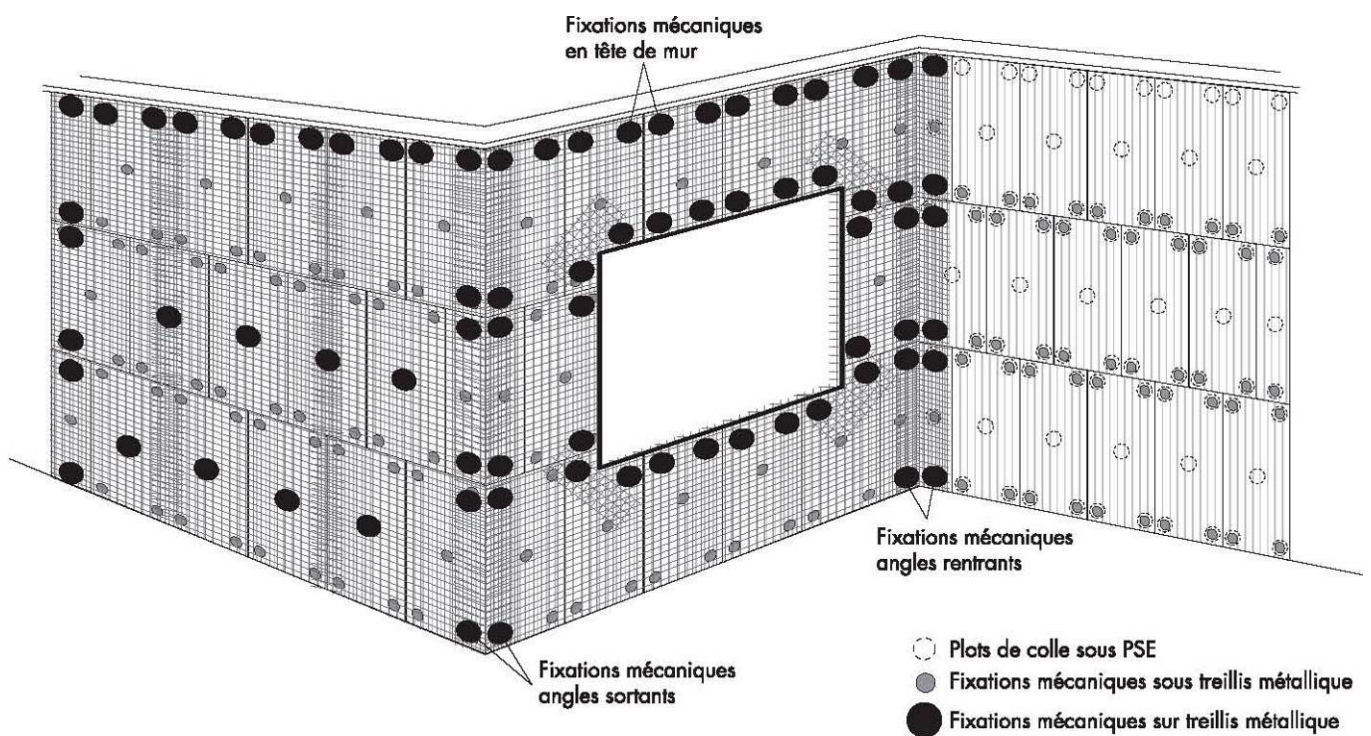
ter – Système fixé mécaniquement par chevilles (rénovation) – plan de chevillage aux points singuliers
